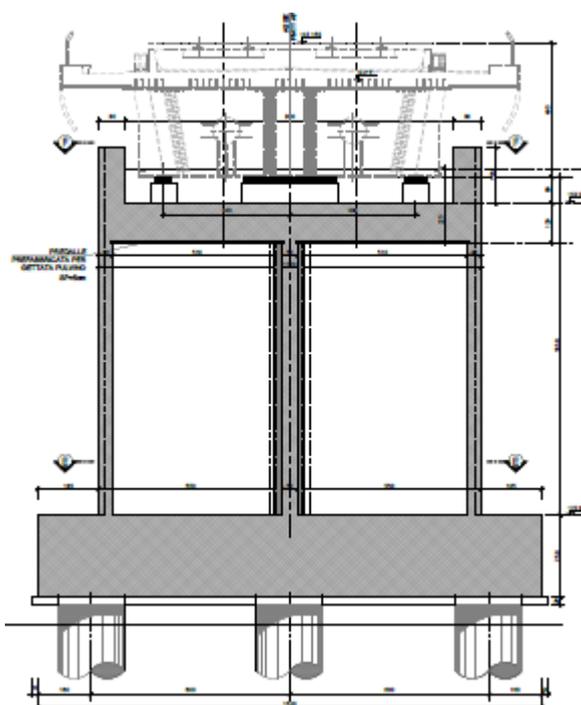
Sezione in direzione trasversale rispetto all'asse del viadotto
